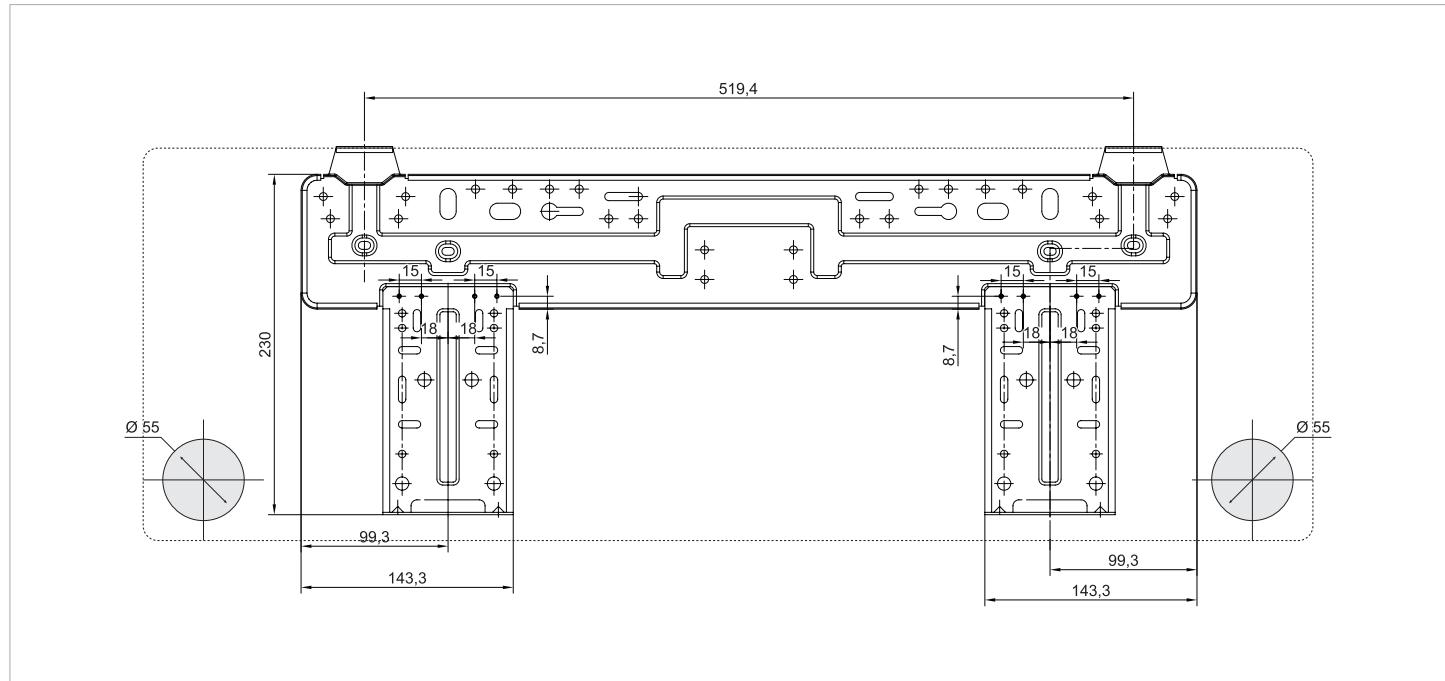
Placa de montagem para 17-025 NMWI.
